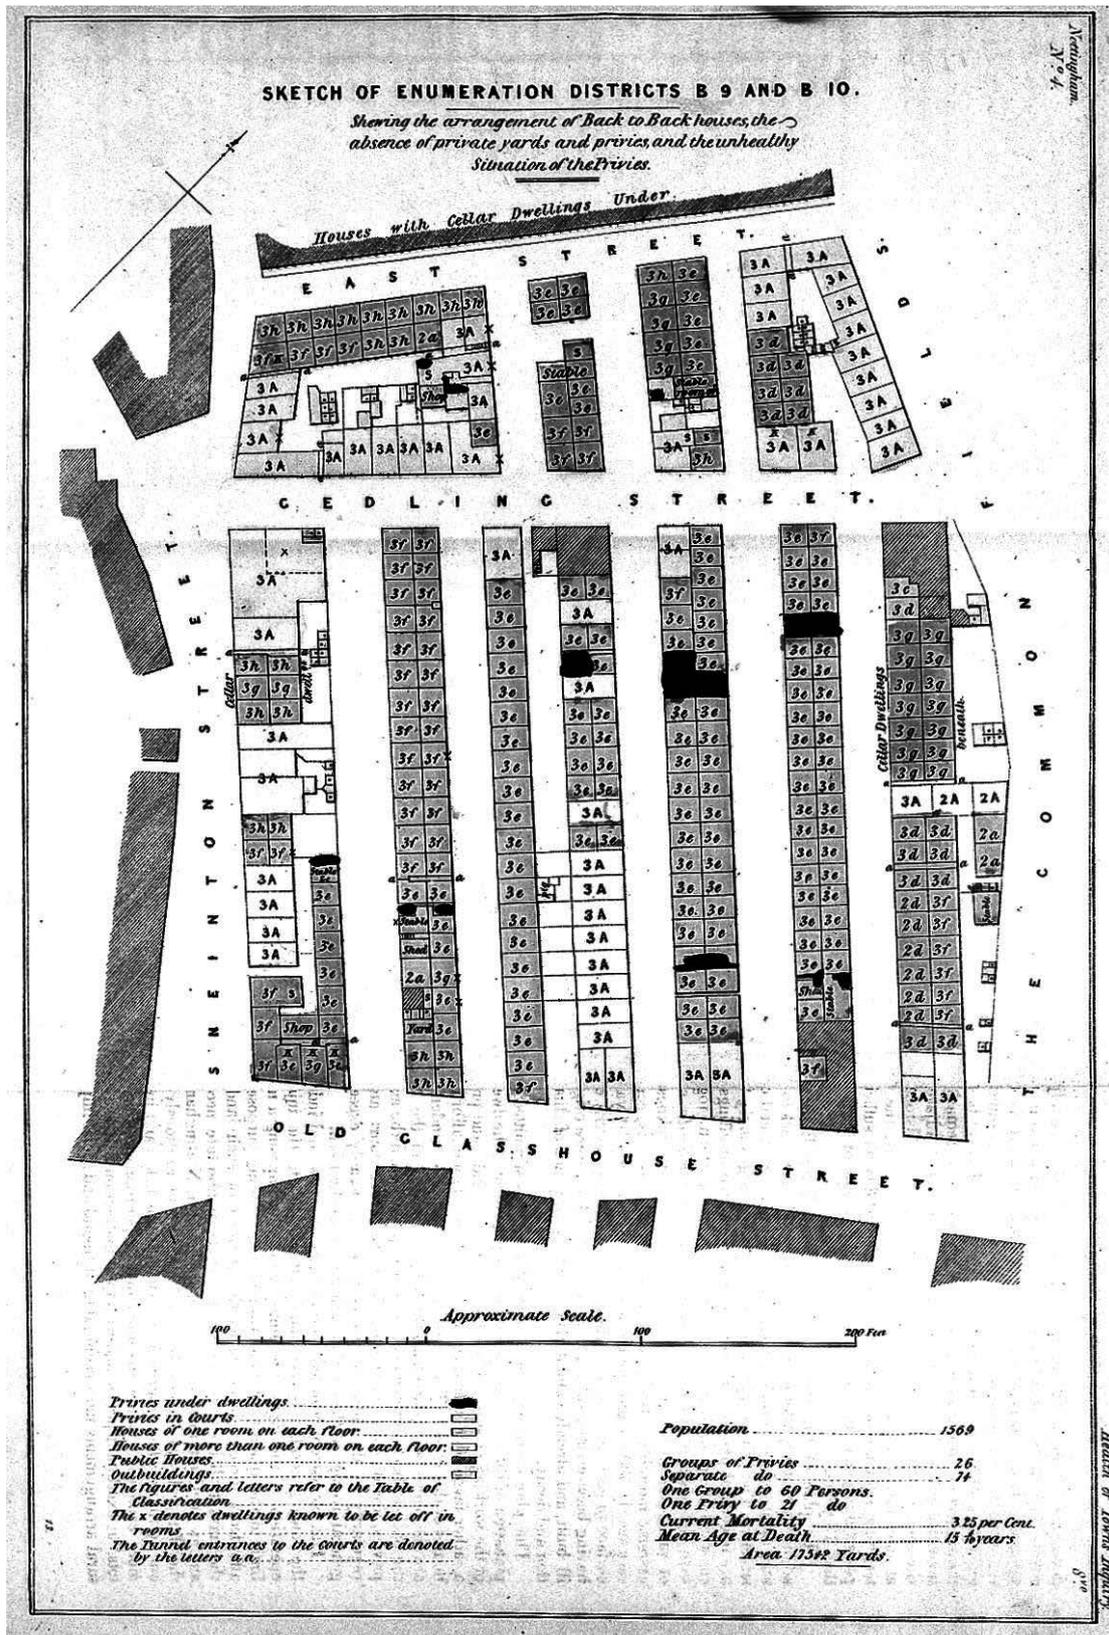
Planta de uma "back to house" na área de Nottingham, Inglaterra
